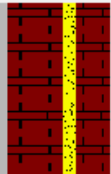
Elementos constructivos de la cubierta plana transitable en la herramienta HULC
